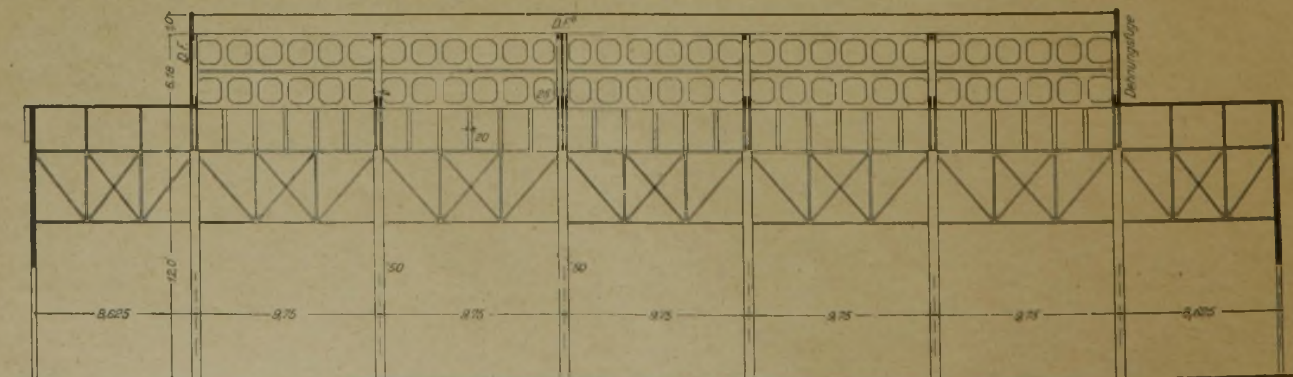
Längsschnitt durch die hohe Halle nach dem Umbau in Eisenbeton.
